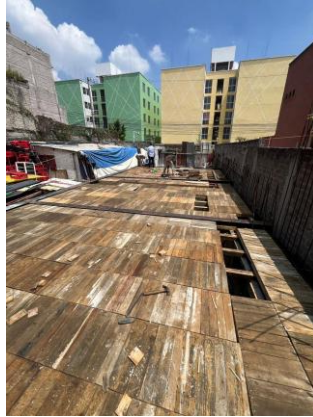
Vista general de la superficie de cimbra lista para recibir el armado de acero
